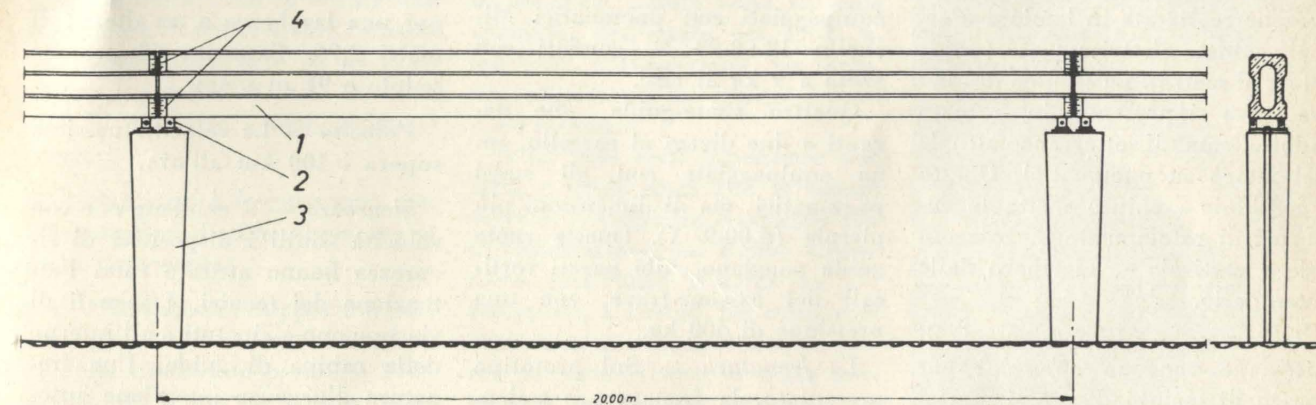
Schema della linea: 1) Travi; 2) Piastre delle travi; 3) Pilastri; 4) Giunti di dilatazione a pettine.
